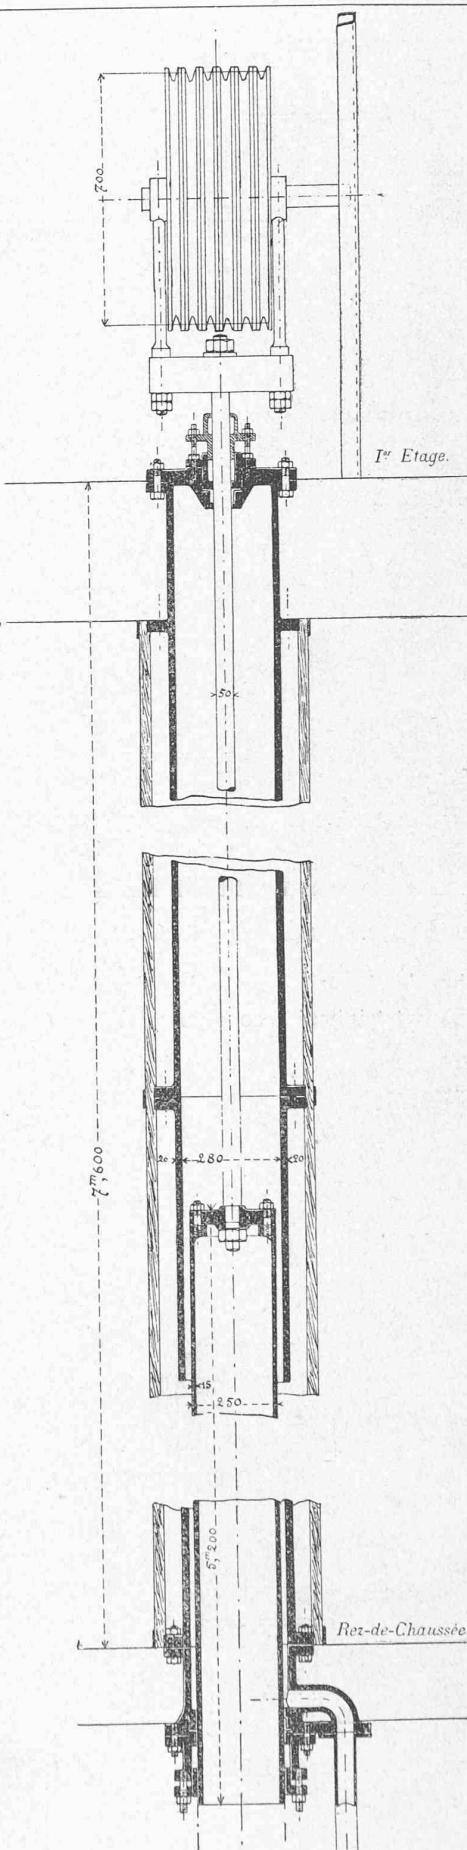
Coupe longitudinale du cylindre moteur. Echelle : 1 : 20.
